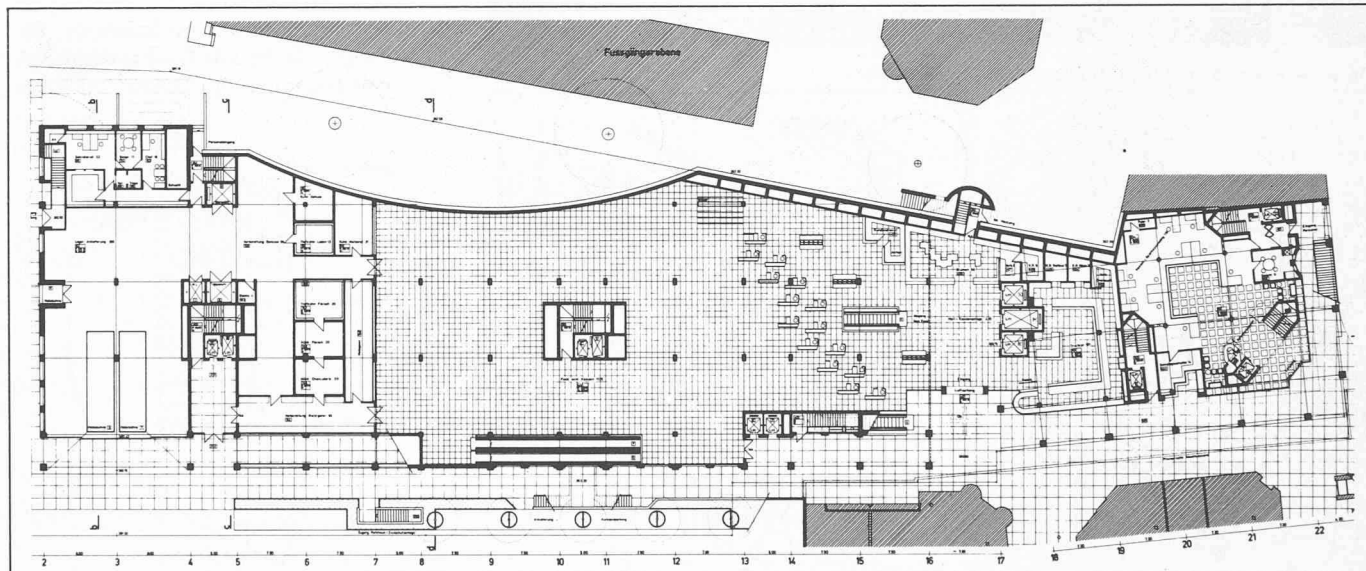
Place et rue de la Gare. Rez-de-chaussée (niveau de la place) avec banque et grands magasins.
